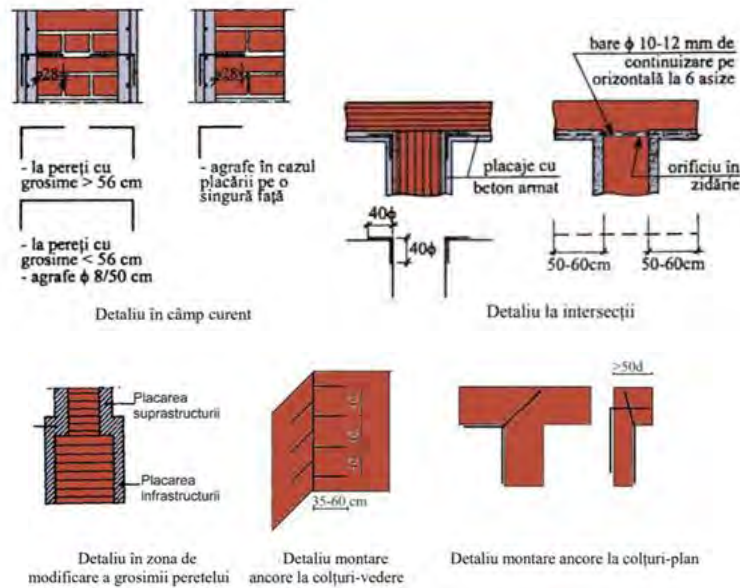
Detalii de placare a zidăriei cu tencuielei armate/beton armat [19]
